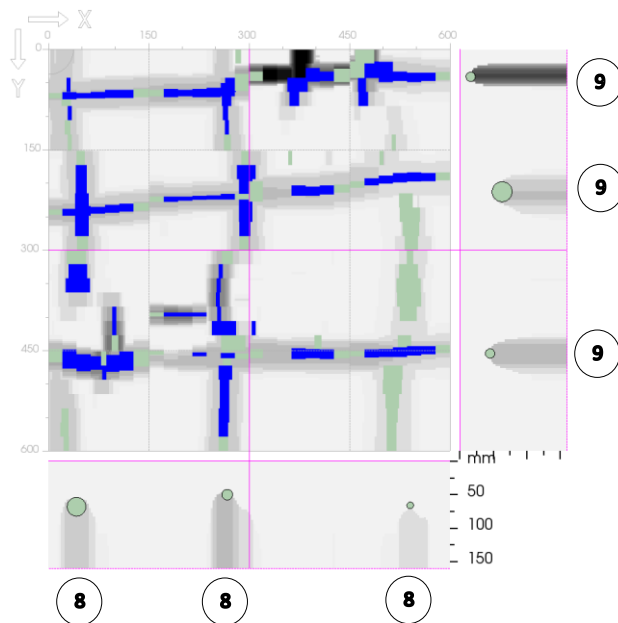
Ferrailage reconnu – Poutre Pt01
